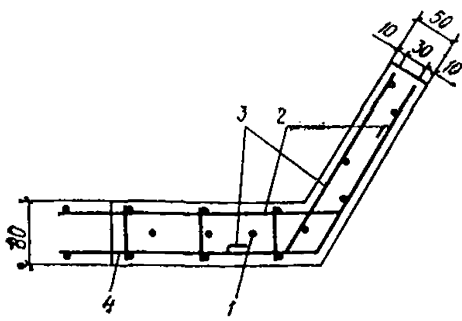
Деталь армирования полки и стенки в торцевой зоне самоанкерования предварительно-напряженной арматуры
